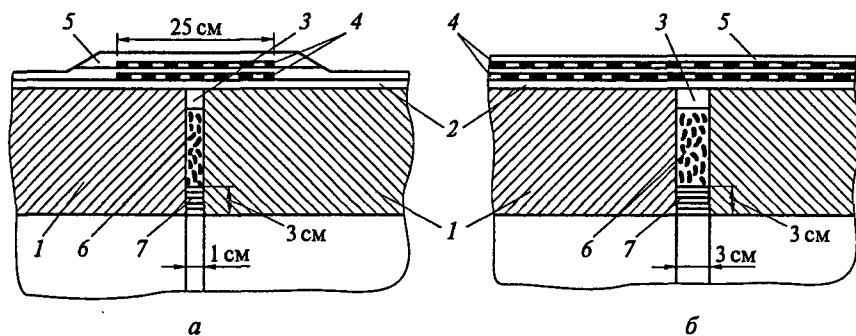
Гидроизоляция стыков звеньев труб:
